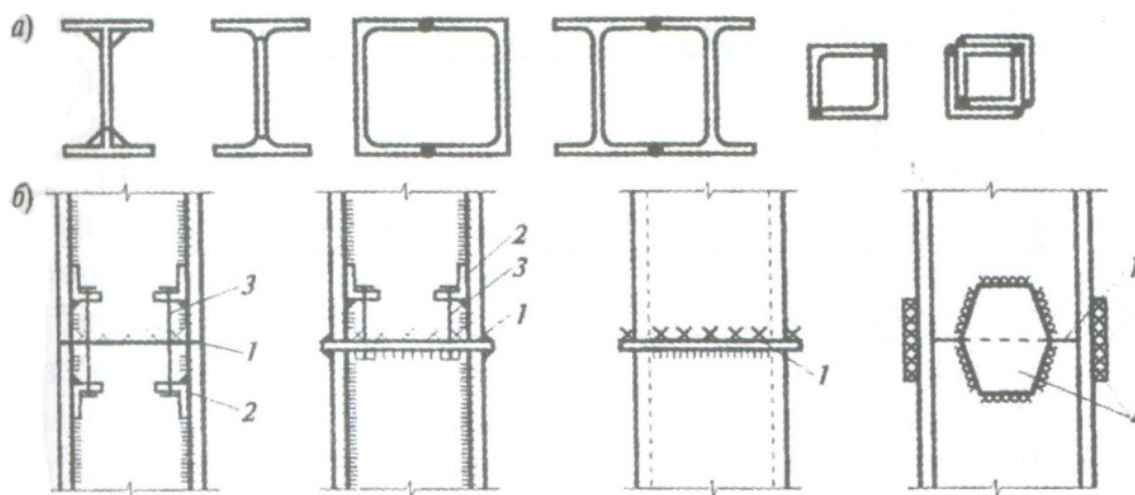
Колонны стального каркаса многоэтажных зданий:
